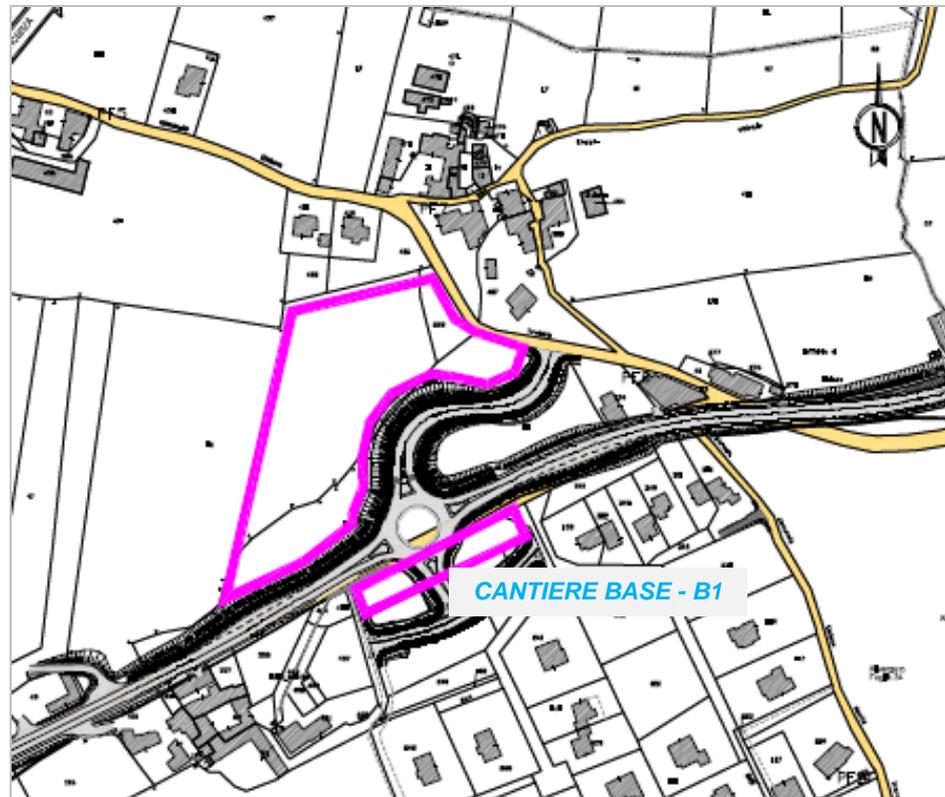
PLANIMETRIA CATASTALE CANTIERE BASE B1
